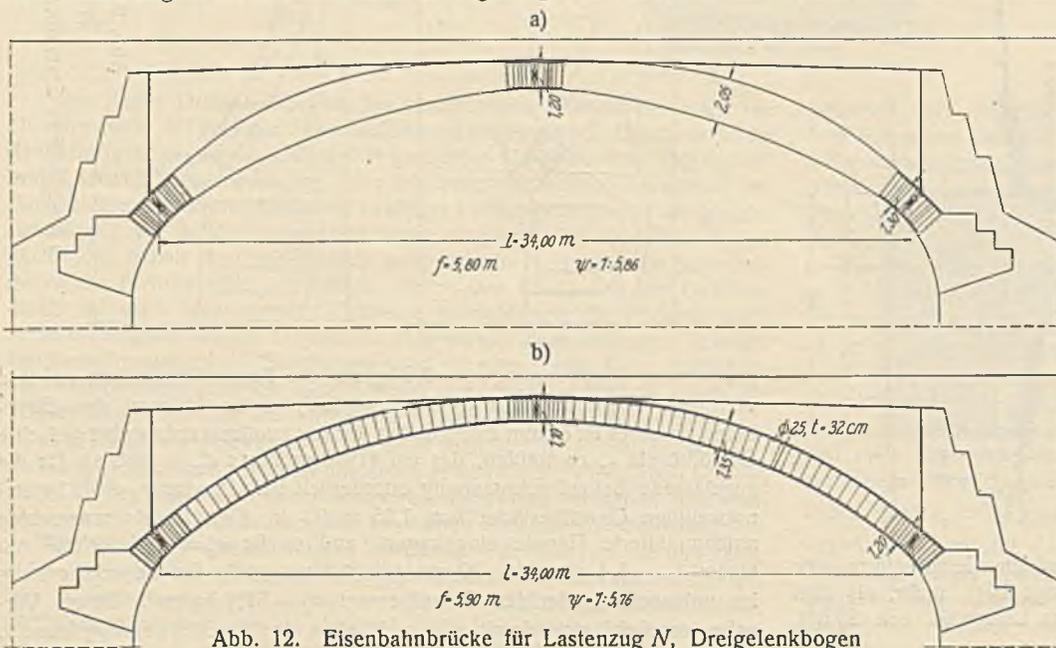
Eisenbahnbrücke für Lastenzug N, Dreigelenkbogen mit Stahlgelenken. a) Ausgeführtes Stampfbetongewölbe. b) Gegenentwurf als bewehrtes Gewölbe.
